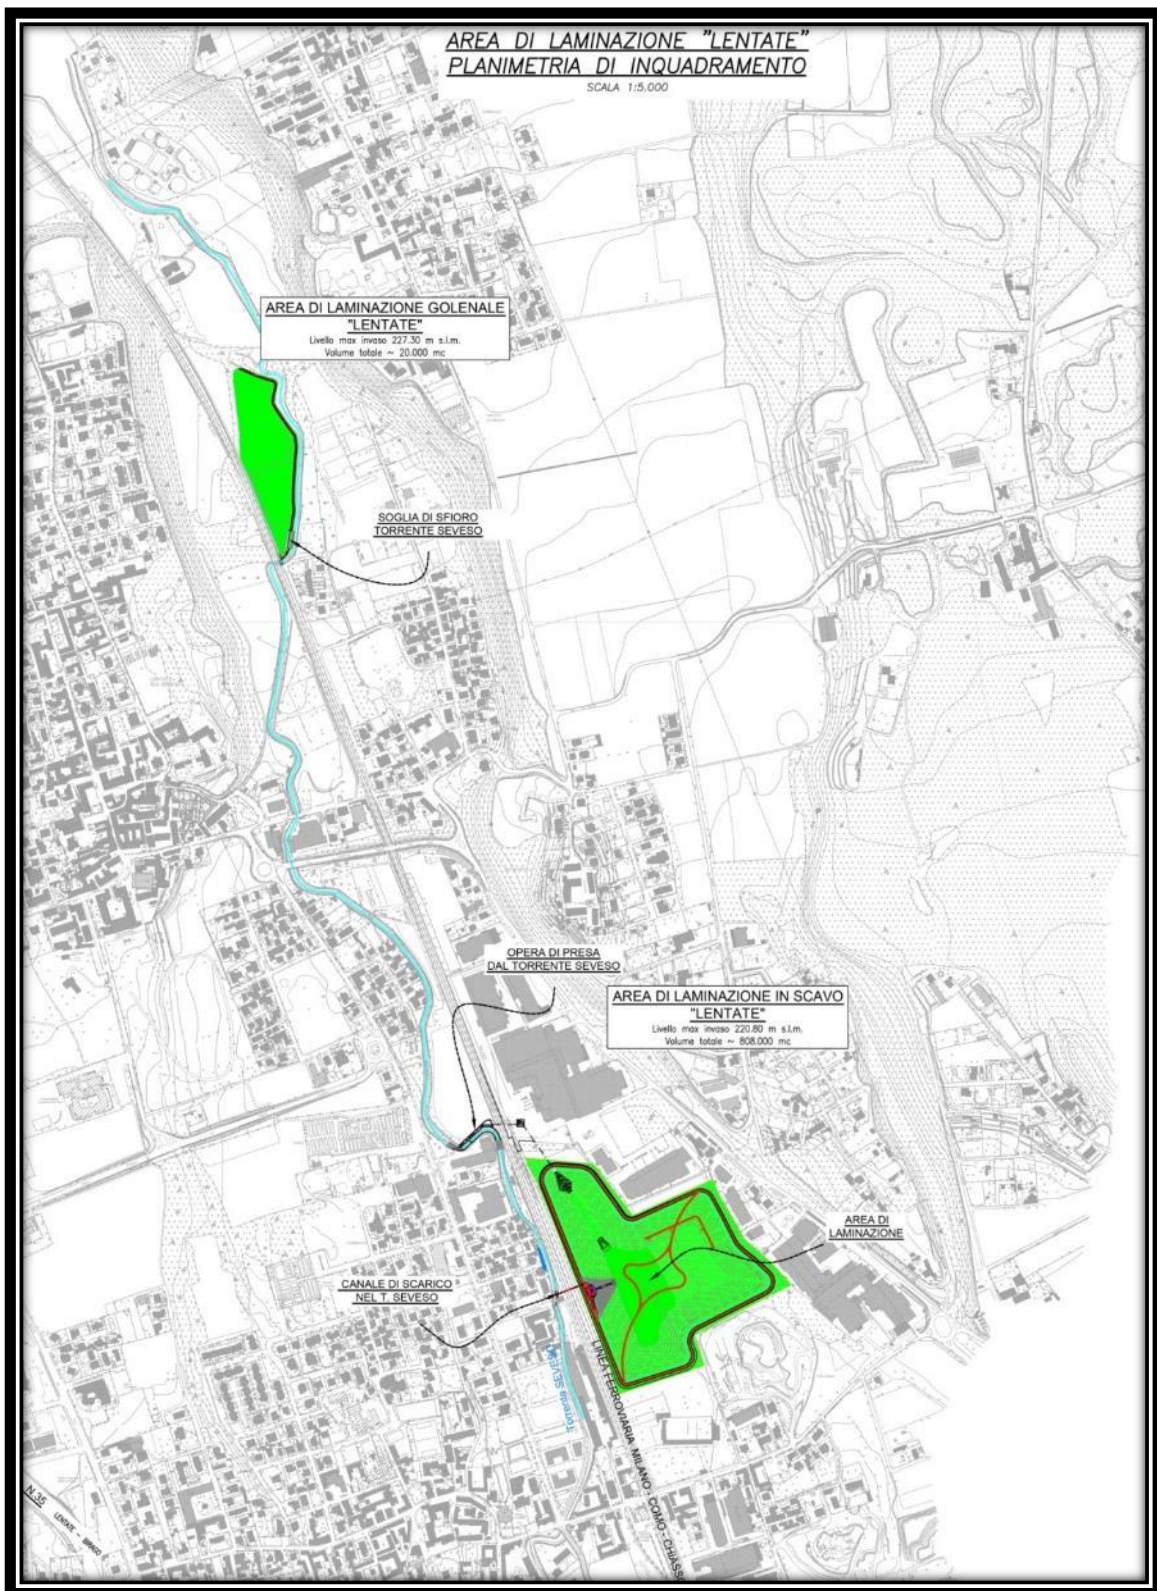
schema planimetrico dell'area di laminazione di Lentate sul Seveso (progetto preliminare).
